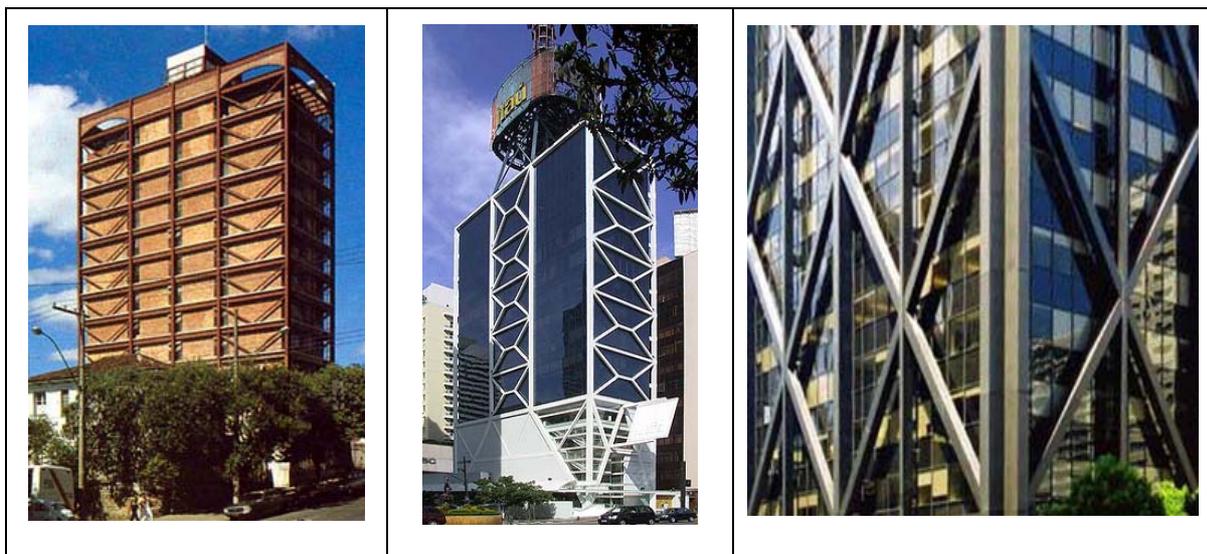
Contraventamento em V (ou K), em Y e em X [26]
